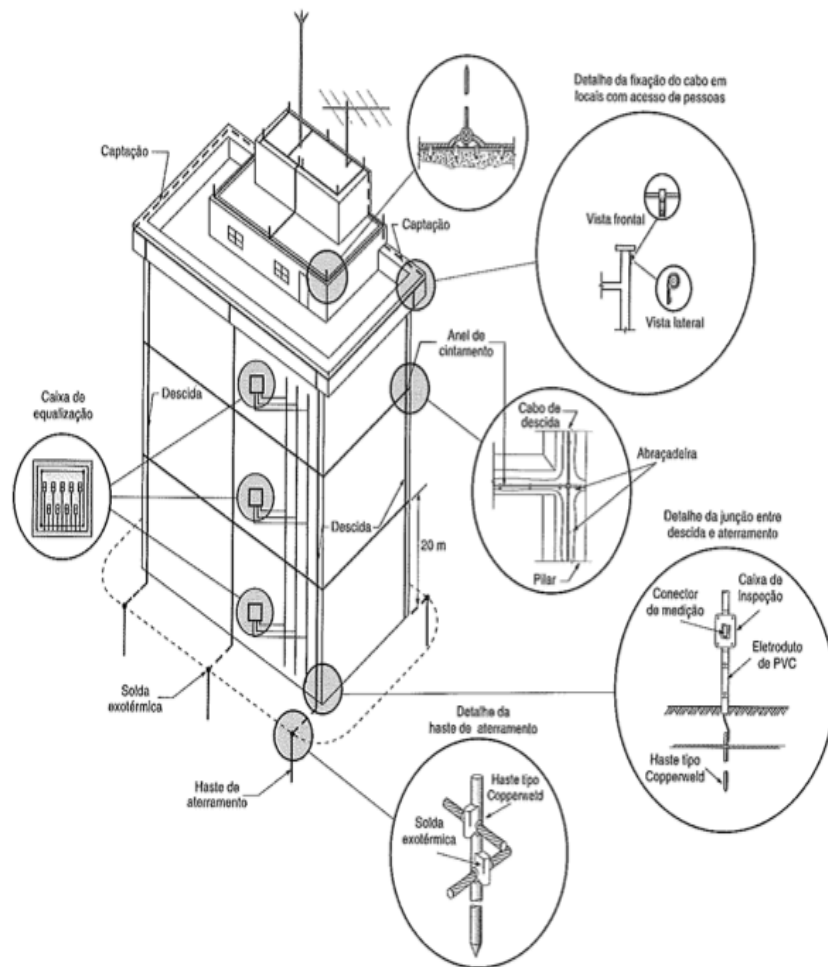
Sistema de proteção aplicado a um prédio. (Termotécnica ®)
